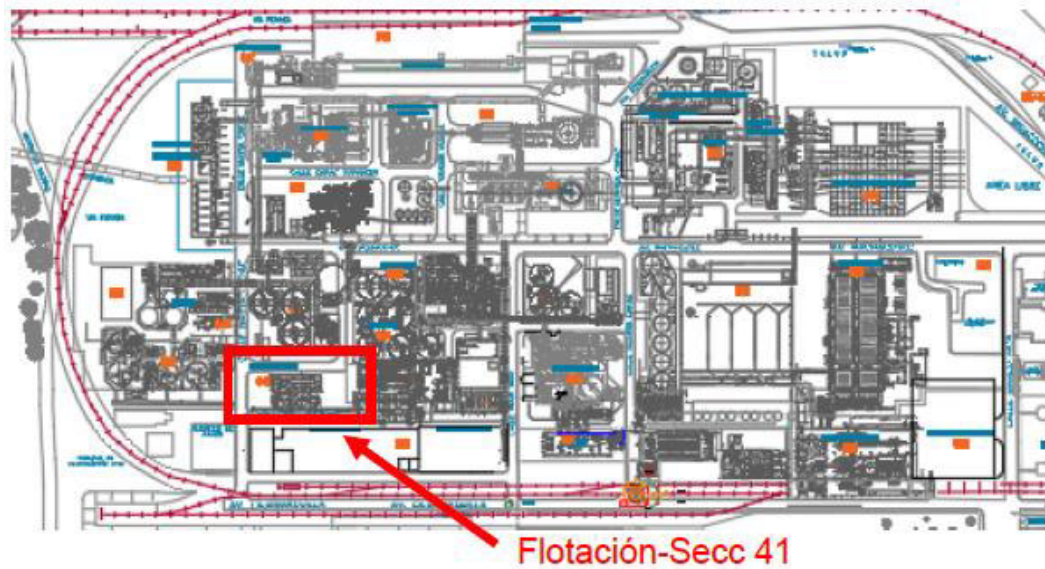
Área de Trabajo Planta Flotación, sección 41.
